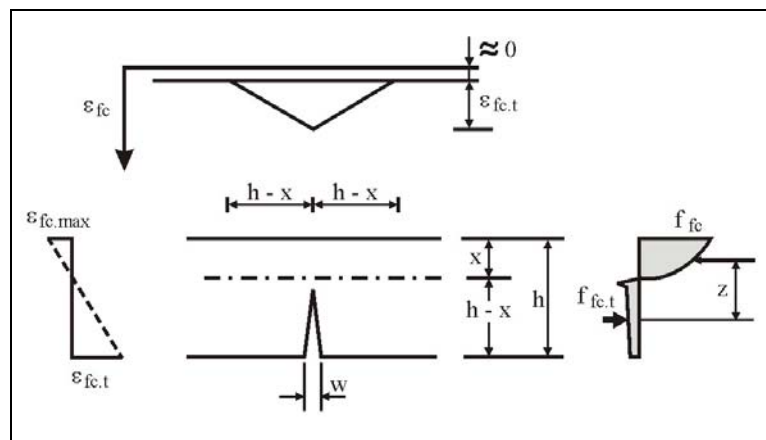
Distribuição de tensões e deformações em vigas de concreto reforçado com fibras de aço (RILEM TC 162 – TDF, 2000b).
